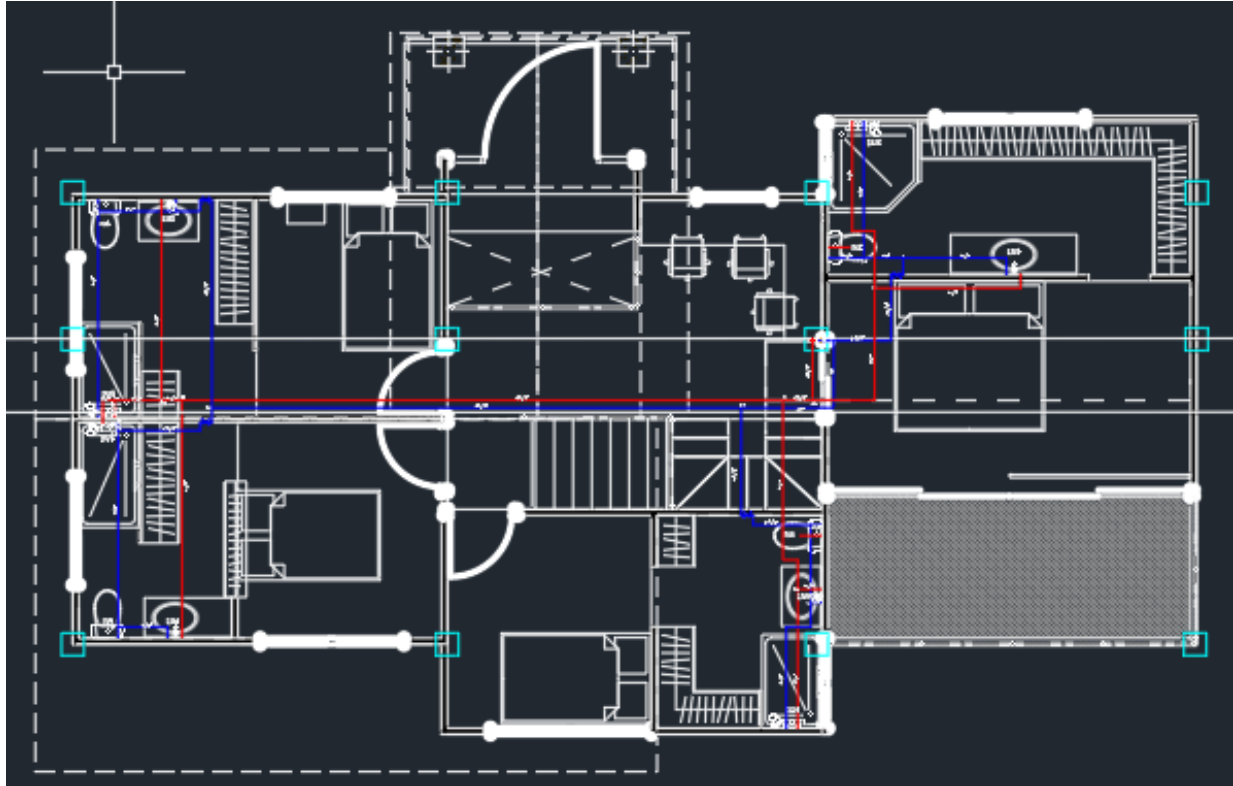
Diseño Hidráulico Planta 2 Casa Piedecuesta
